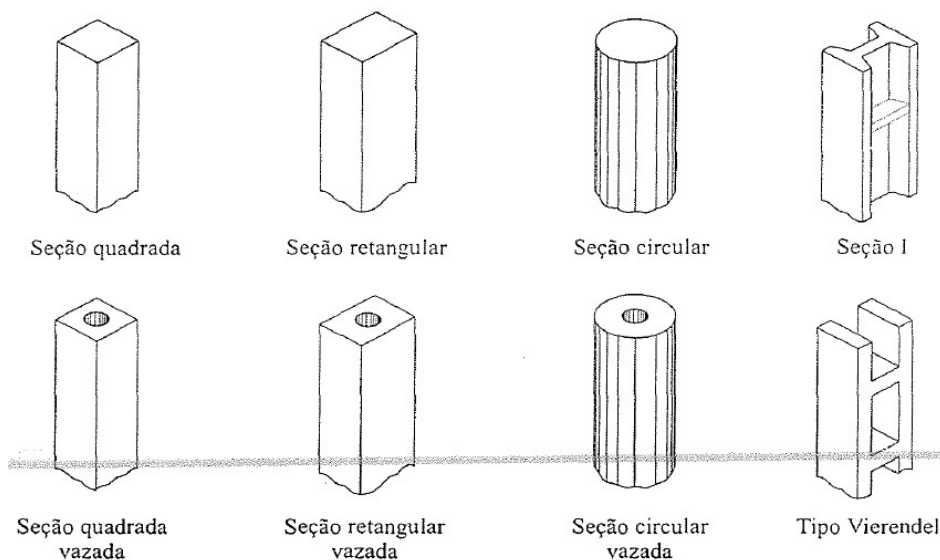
Seções transversais utilizadas nos pilares (Els Debs, 2000)
